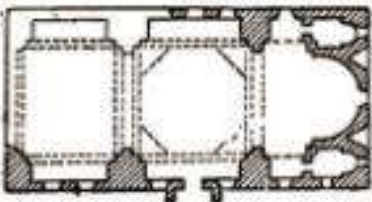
Центричний купольний храм палацу Звартноц. 640-660-ті роки
